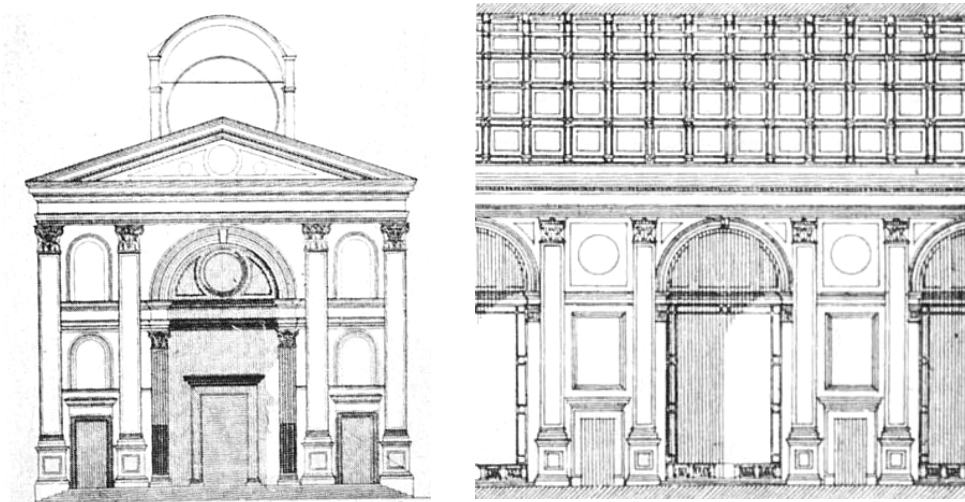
Fachada e corte do projeto de Alberti para Sant'Andrea de Mântua (1470-1494).
